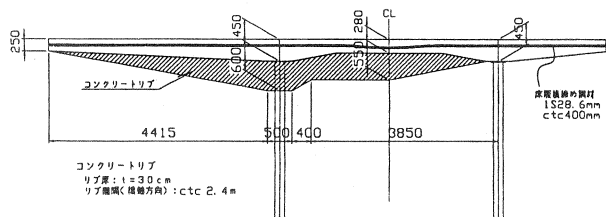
コンクリートリブ付き床版形状およびP C鋼材配置
